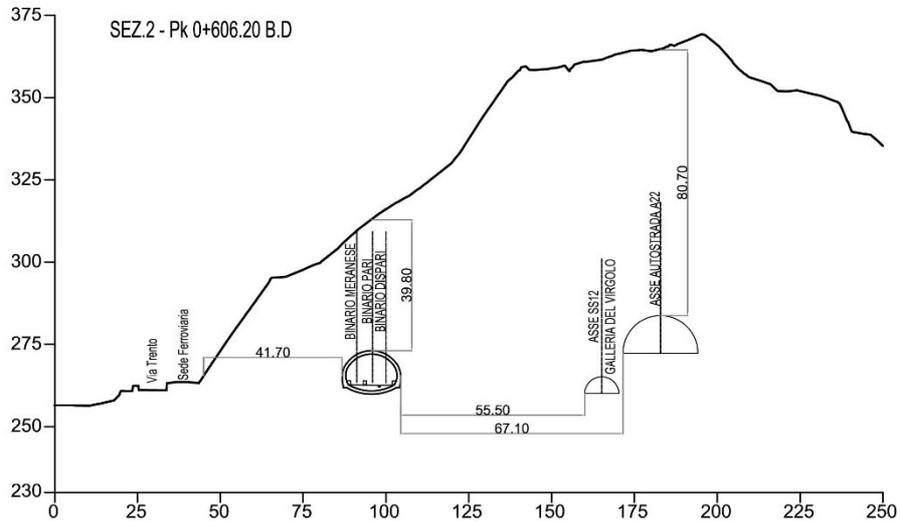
Planimetria dell'opera in sottoterraneo con sezioni
